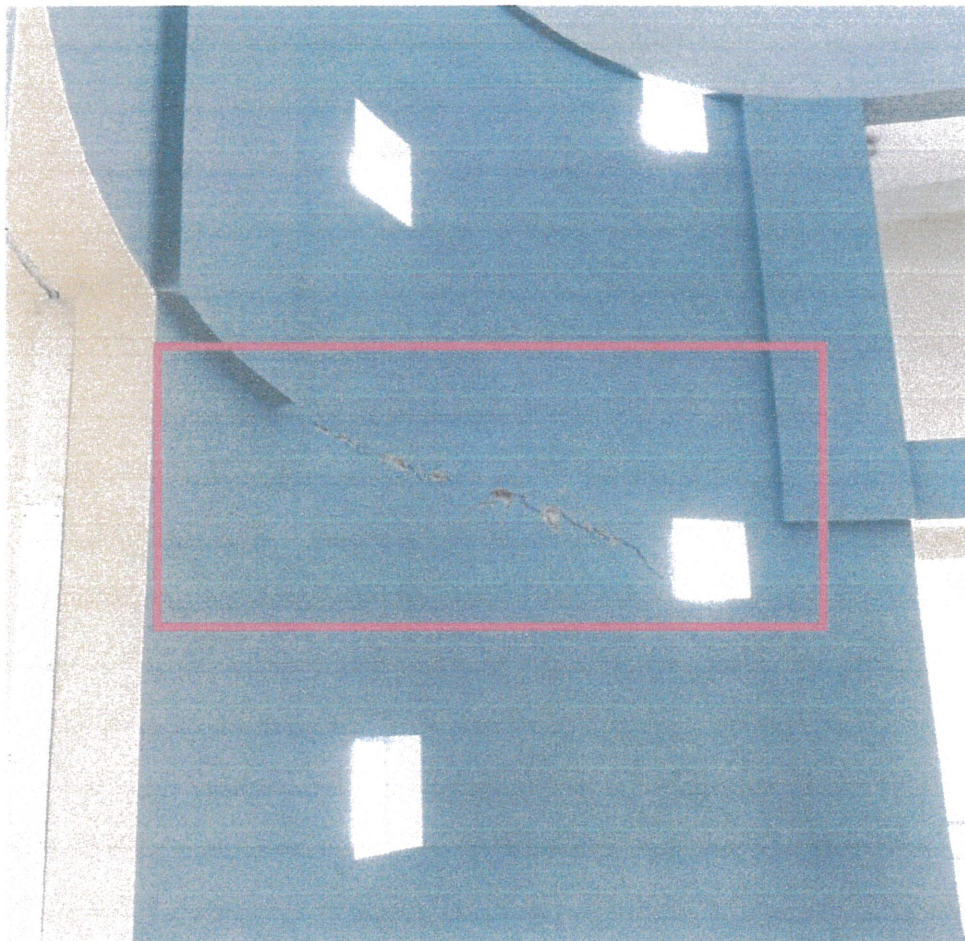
Presencia de grietas horizontales en la junta fría de muro con viga principal en el frontis del vicerrectorado académico vista en la parte posterior de la vista anterior.
